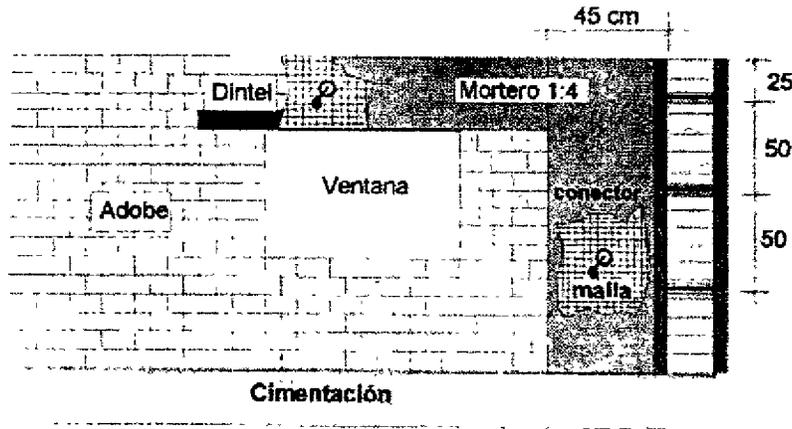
Muro de adobe reforzado con malla electrosoldada
